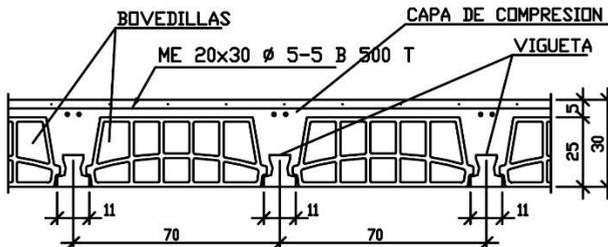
Detalle forjado. 2017. Proyecto Básico y de Ejecución del edificio
